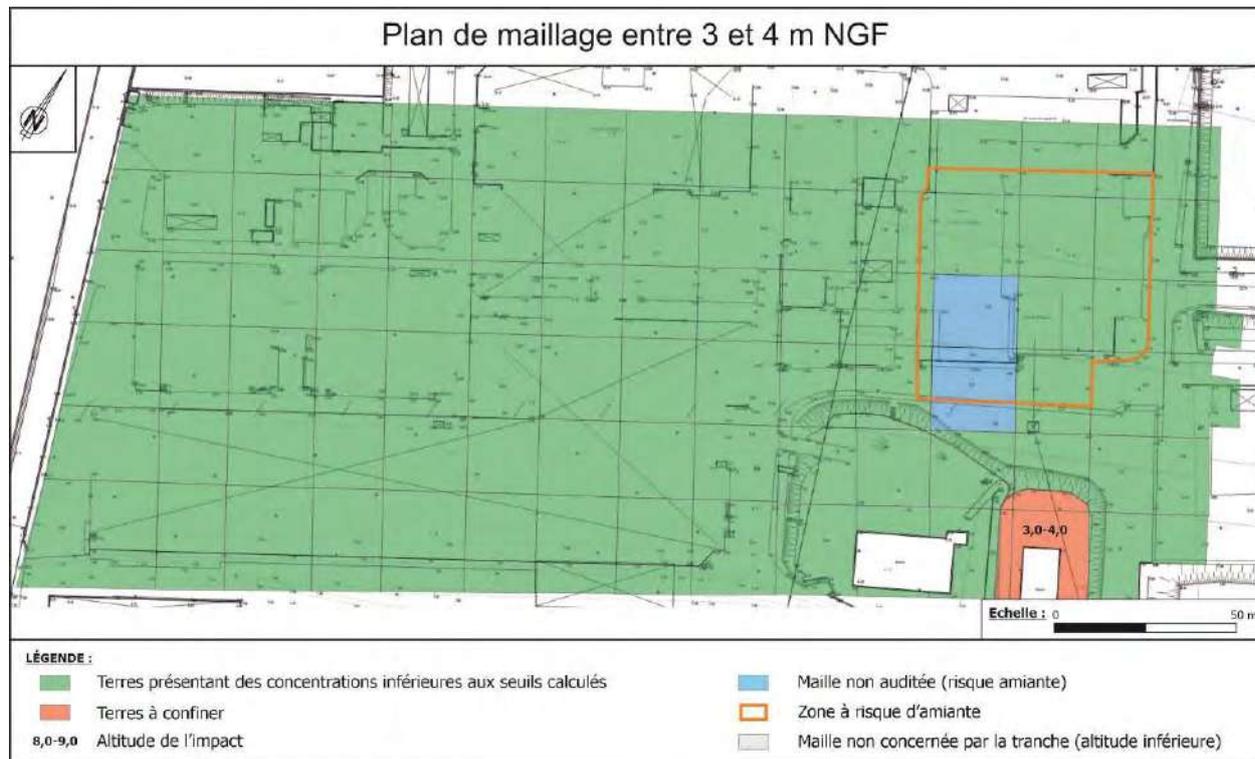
Plan de maillage entre 3 et 4 m NGF
